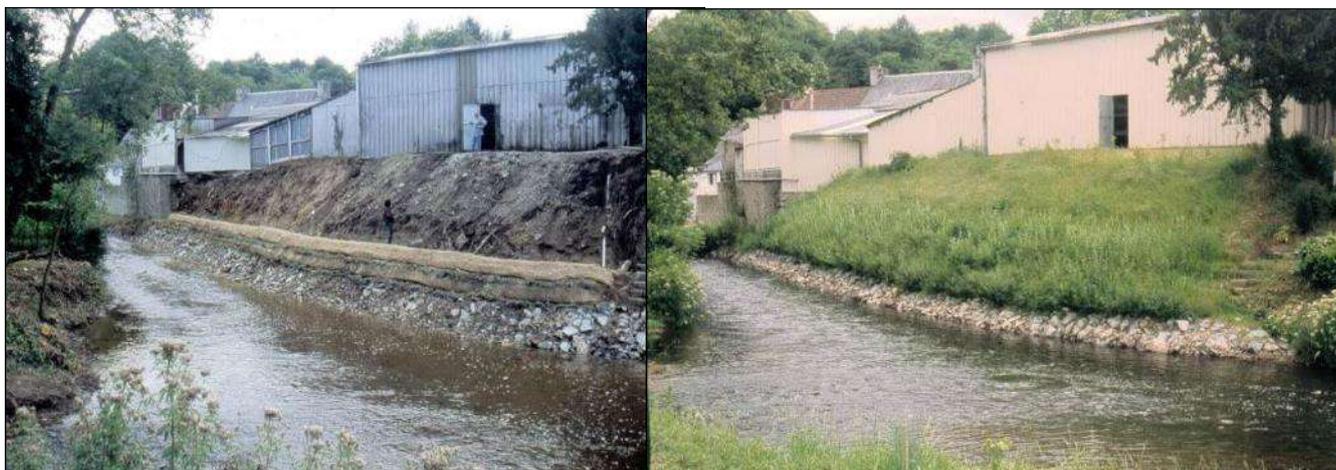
Exemple de chantier de restauration et stabilisation de berges au moyen de techniques mixtes : empierrement sous-fluvial et lits de plants et plançons renforcés par des boudins de géotextile. Etat de l'ouvrage en cours de chantier puis six
